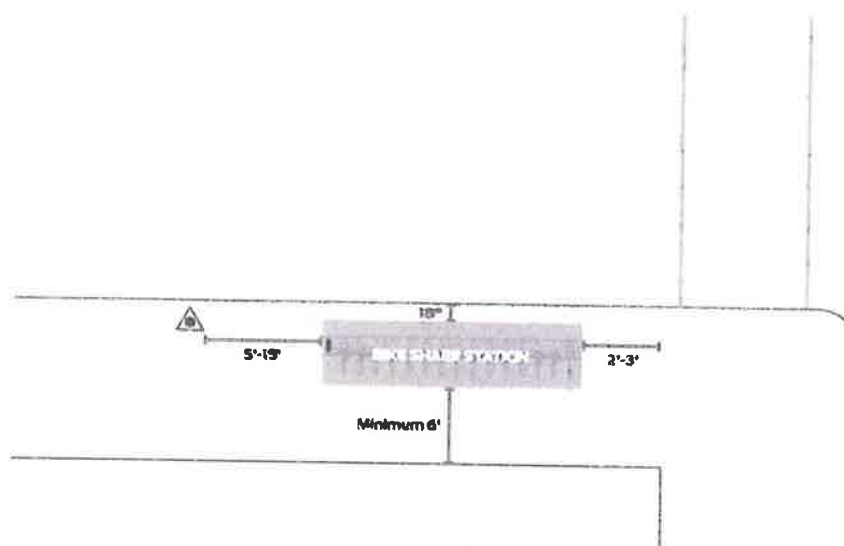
Schemă stație pe trotuar (Sursa: NACTO UBDG)
